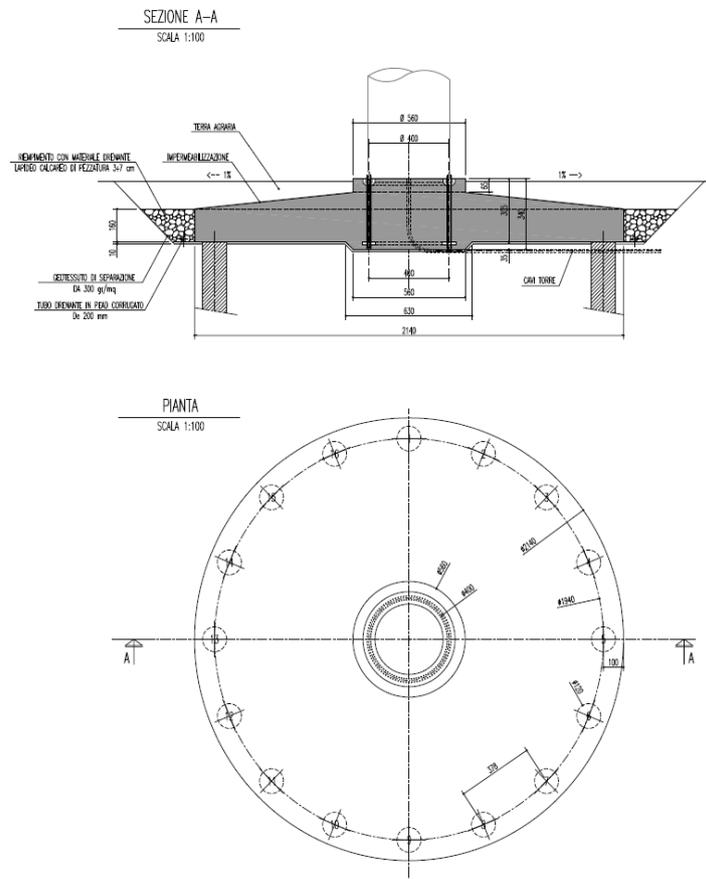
Tipologia della fondazione su pali prevista
